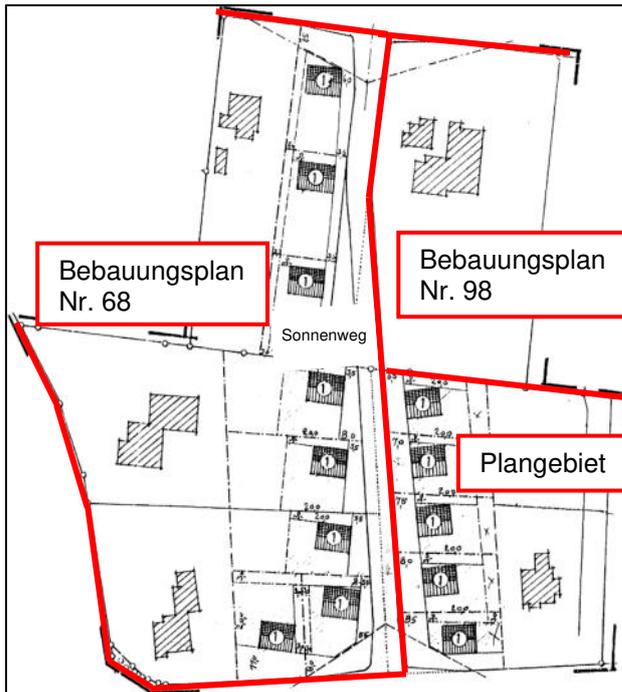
Übersichtsplan der bestehenden Bebauungspläne, ohne Maßstab
